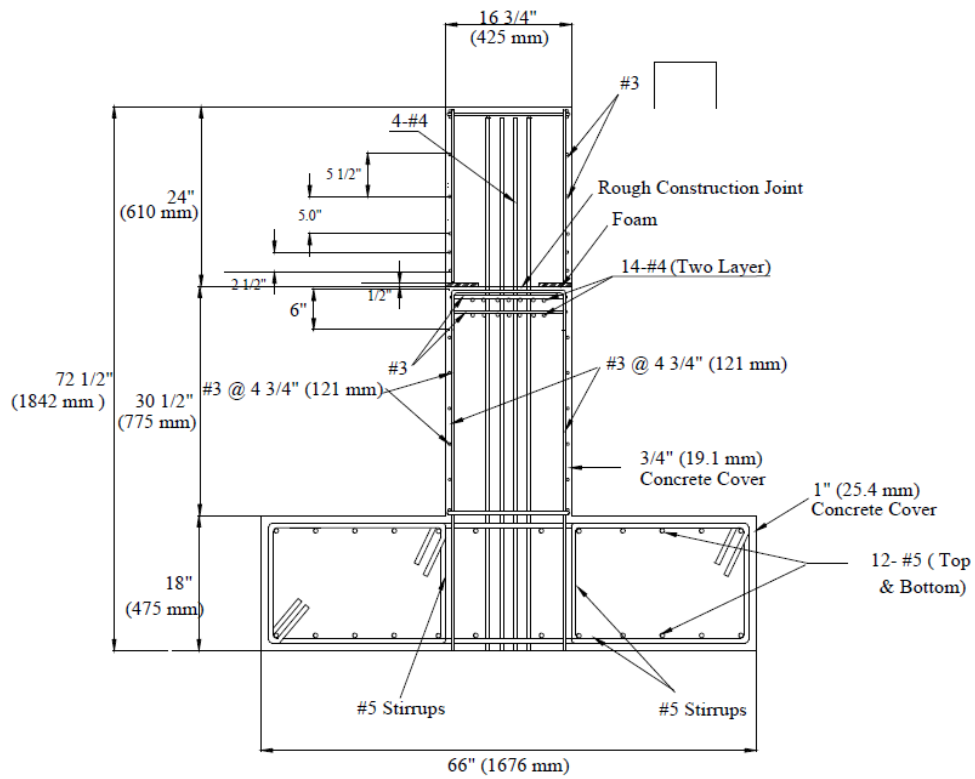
Sección A-A de Refuerzos – Serie 5 Externa (Bozorgzadeh et al., 2007).
